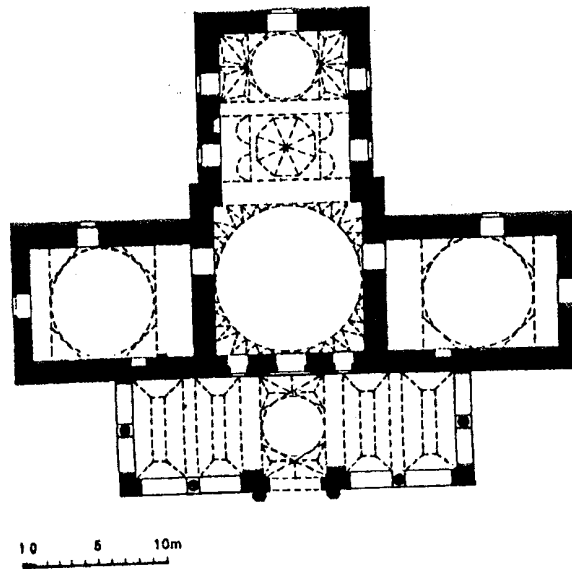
مسقط أفقي لجامع فيروز بك في ميلاس (عن : Goodwin)
